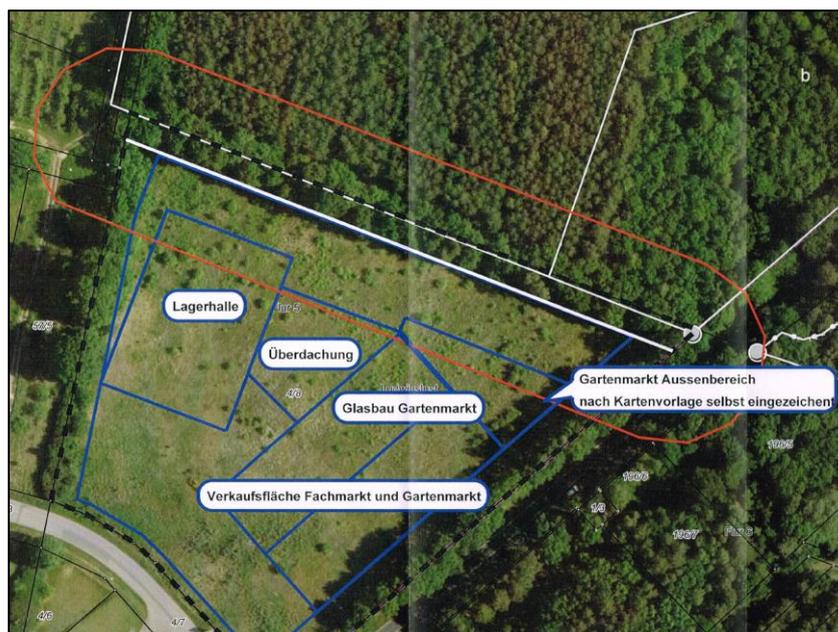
Lageplan (Quelle: Stellungnahme Forstamt Grabow vom 16.07.2020)
